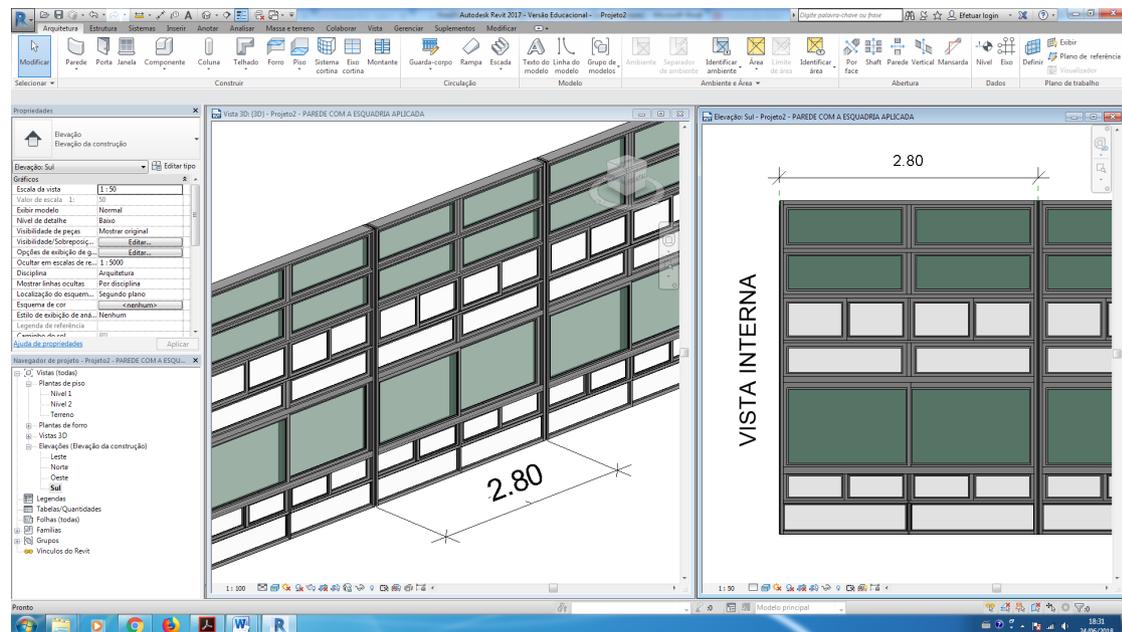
Modelagem componente principal, aplicado em parede-cortina. Fonte: AUTOR (2018).
